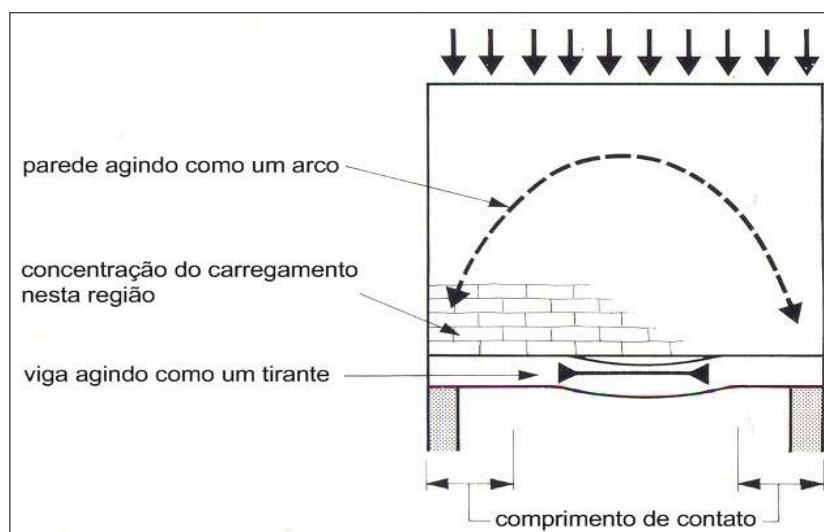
Efeito arco entre parede e viga de transição. (Fonte: Paes, 2008)
